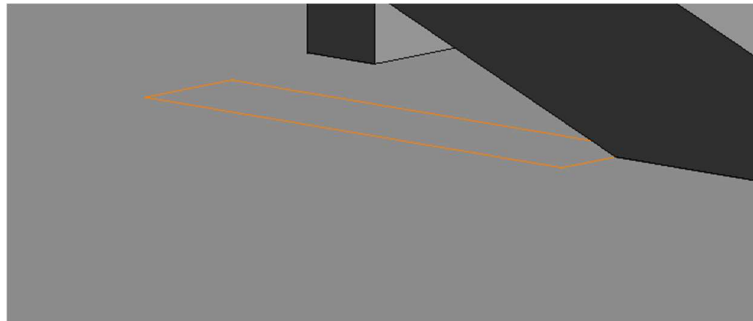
Viga de fundação inserida na laje térrea (detetado através dos *Warnings*).
